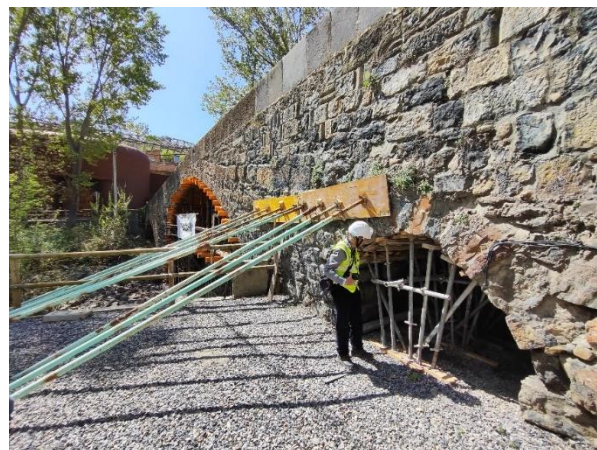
Vista del apeo exterior del tímpano sobre pila 1.
